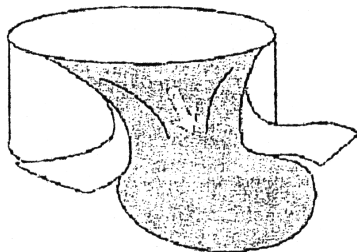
Разрушение корпуса резервуара по схеме «бурный поток» [14]
